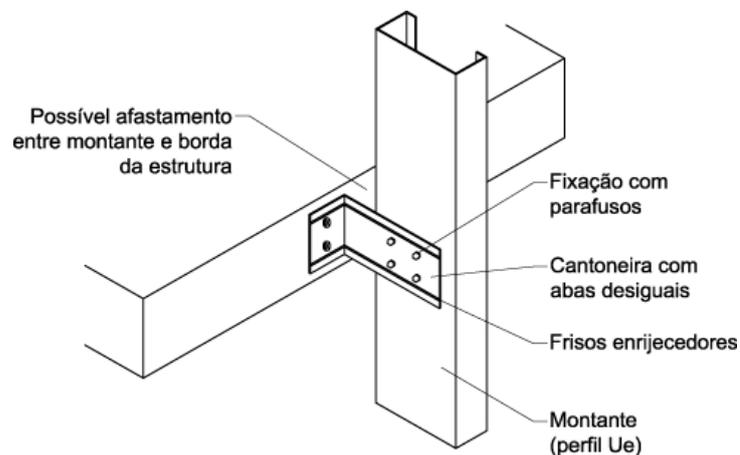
Ligação rígida com cantoneira de aba longa
